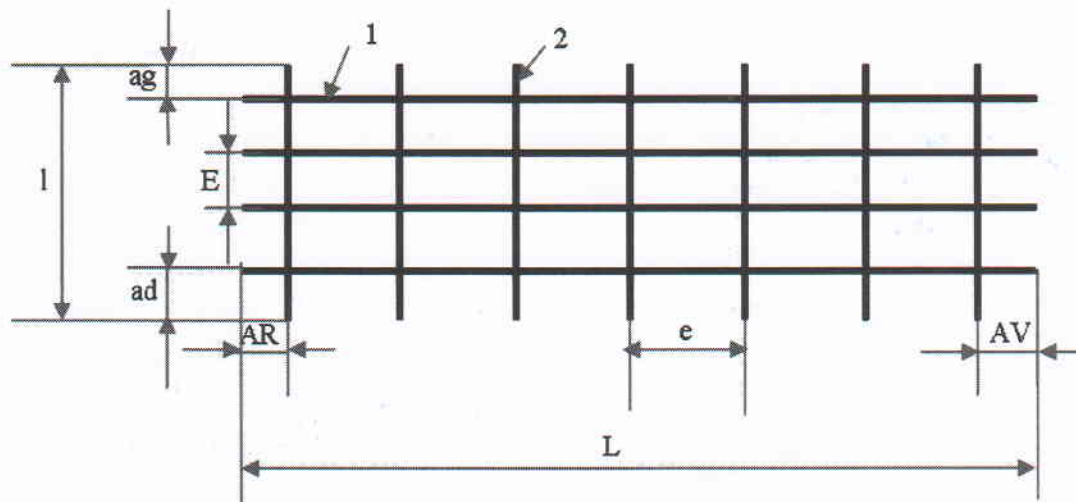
Aspect géométrique des treillis soudés de surface
